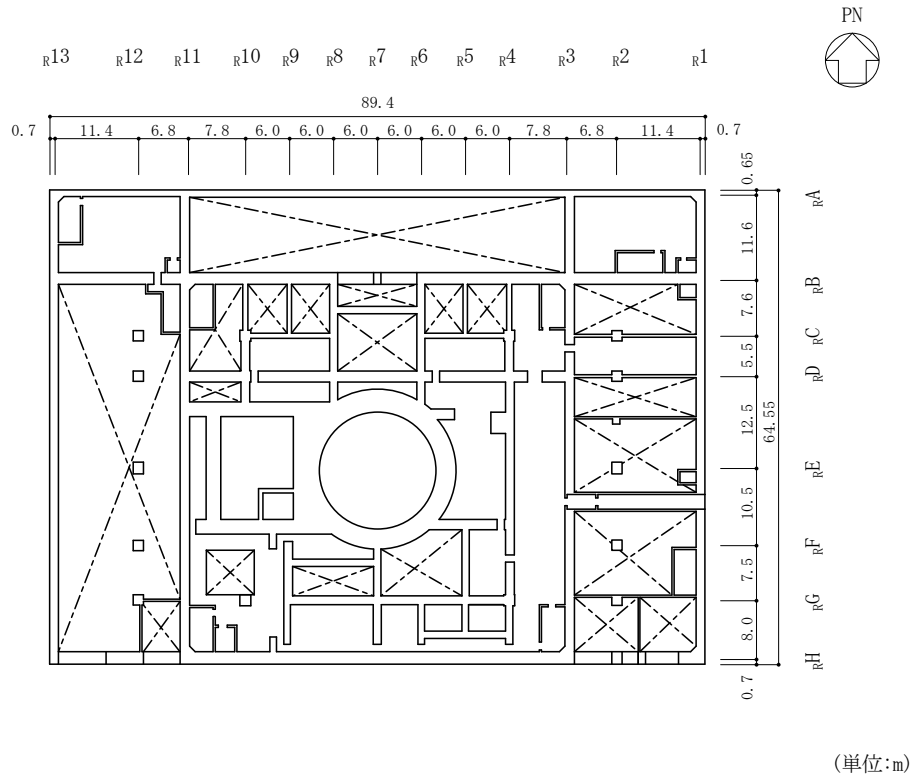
(5) 原子炉建物の概略平面図 (EL 30.5m)
